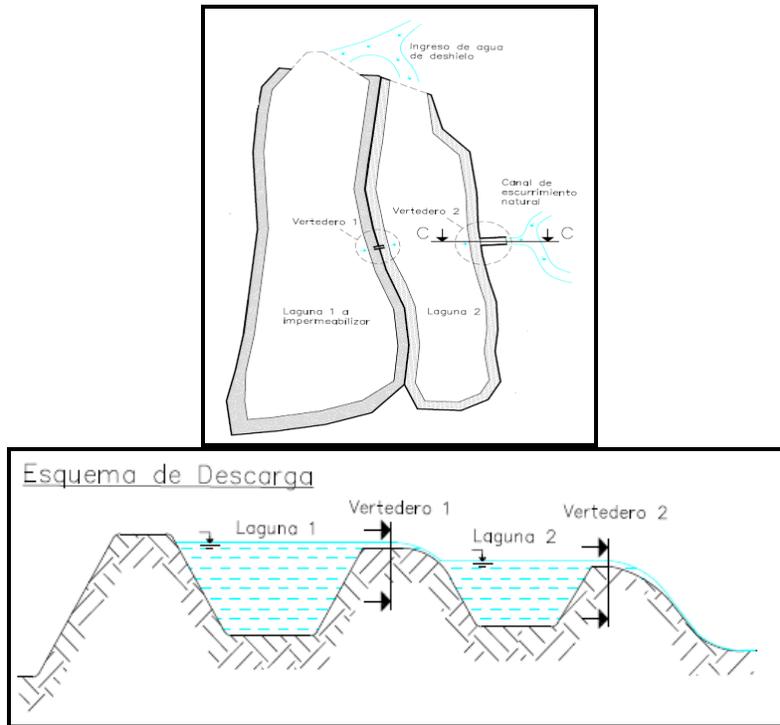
Esquema en planta de ambas lagunas y corte transversal a la altura de los vertederos.
